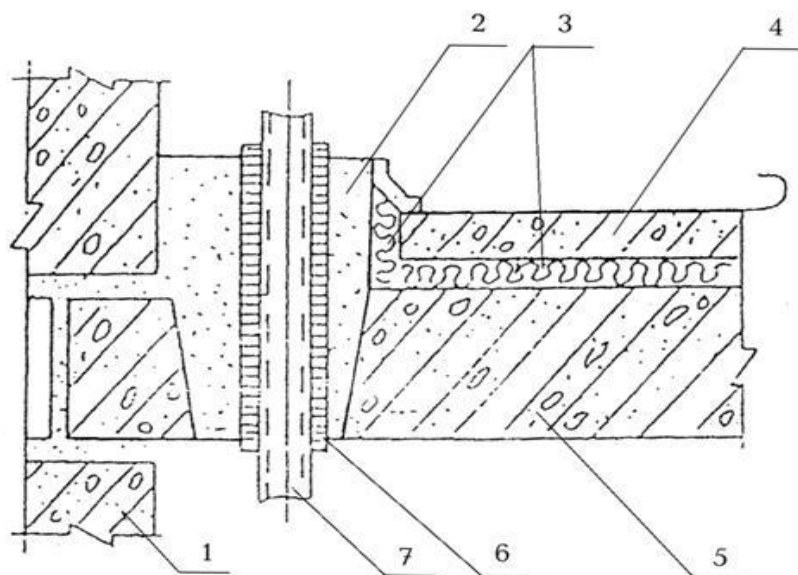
Схема конструктивного решения узла пропуска стояка отопления через междуэтажное перекрытие: 1 – стена; 2 – безусадочный бетон или раствор; 3 – прокладка (слой) из звукоизоляционного материала; 4 – бетонное основание пола; 5 – несущая часть перекрытия; 6 – эластичная гильза; 7 – труба стояка отопления.
